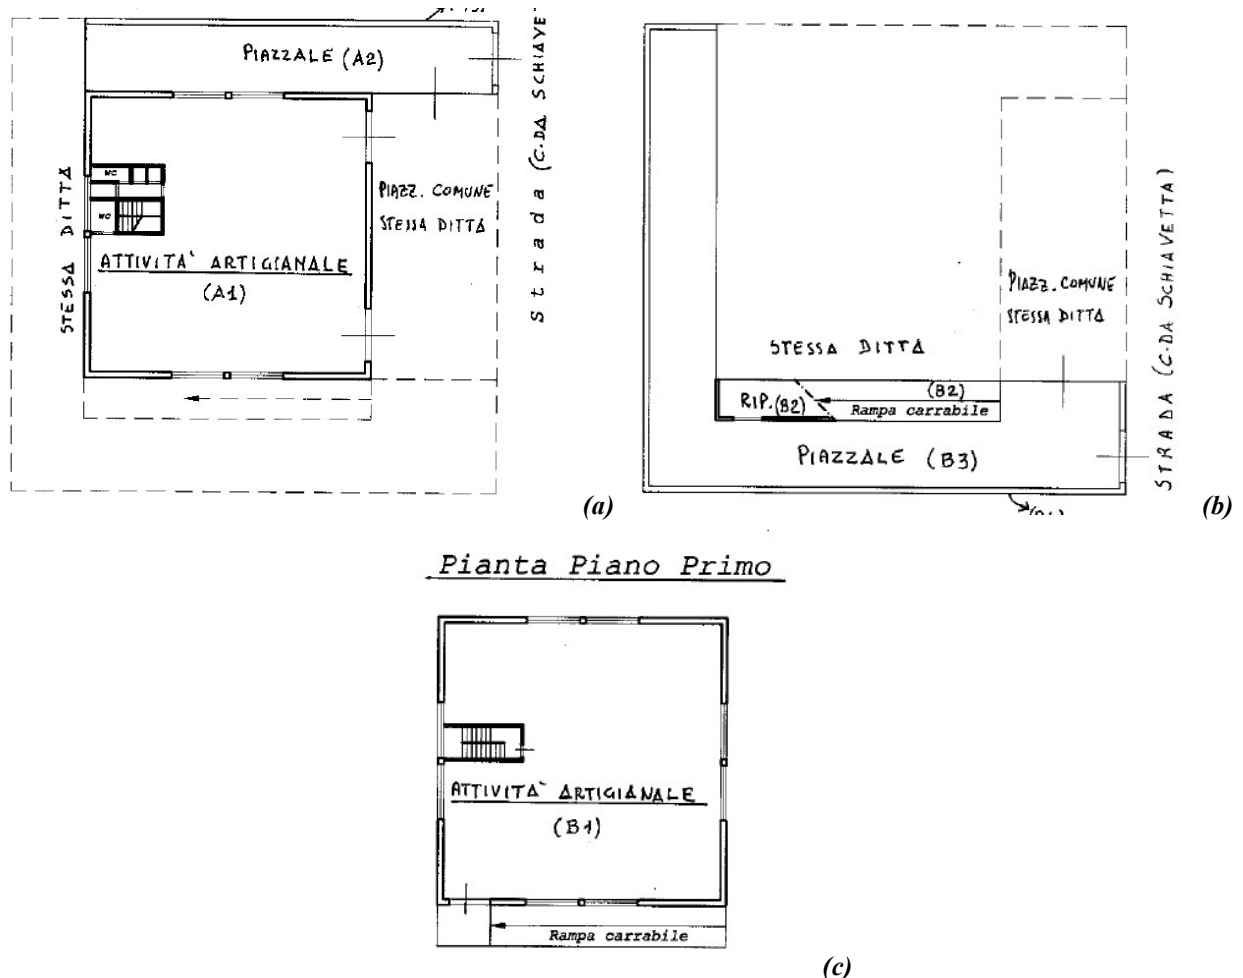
Planimetrie catastali del capannone: piano terra - subalterno 2 (a); piano terra - subalterno 3 (b); piano primo - subalterno 3 (c).
